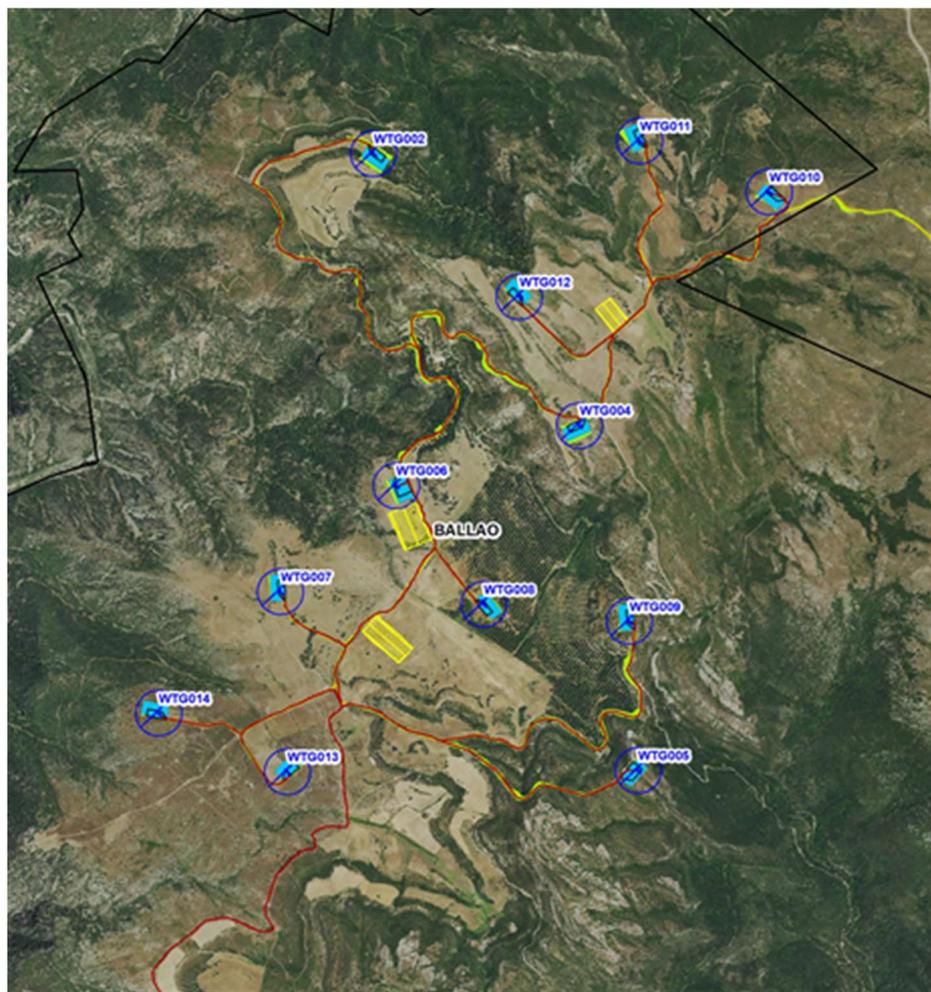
Alternativa di layout proposta rispetto alla configurazione di progetto agli atti
